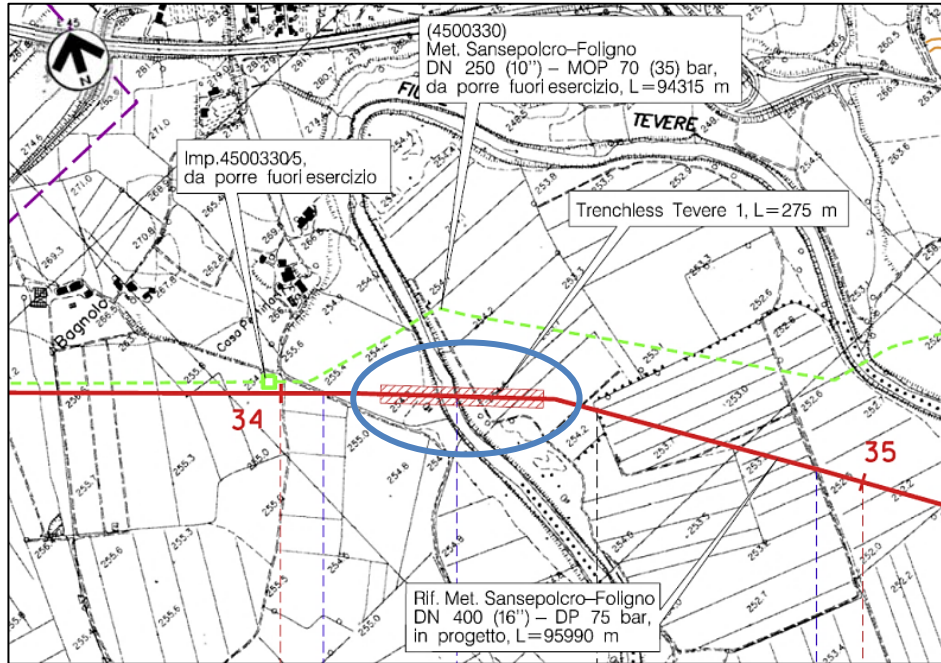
/B – Stralcio CTR con localizzazione dell'attraversamento
